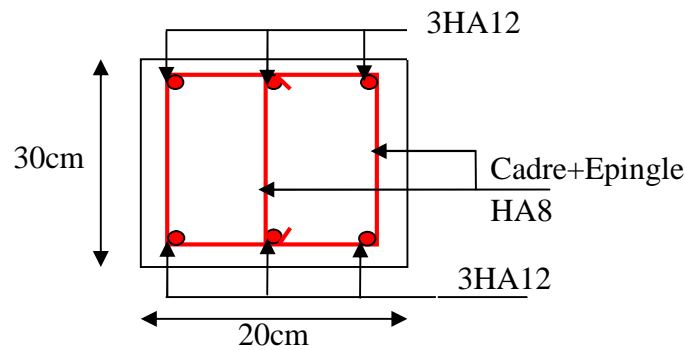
Schéma de ferrailage de la poutre de chaînage.
